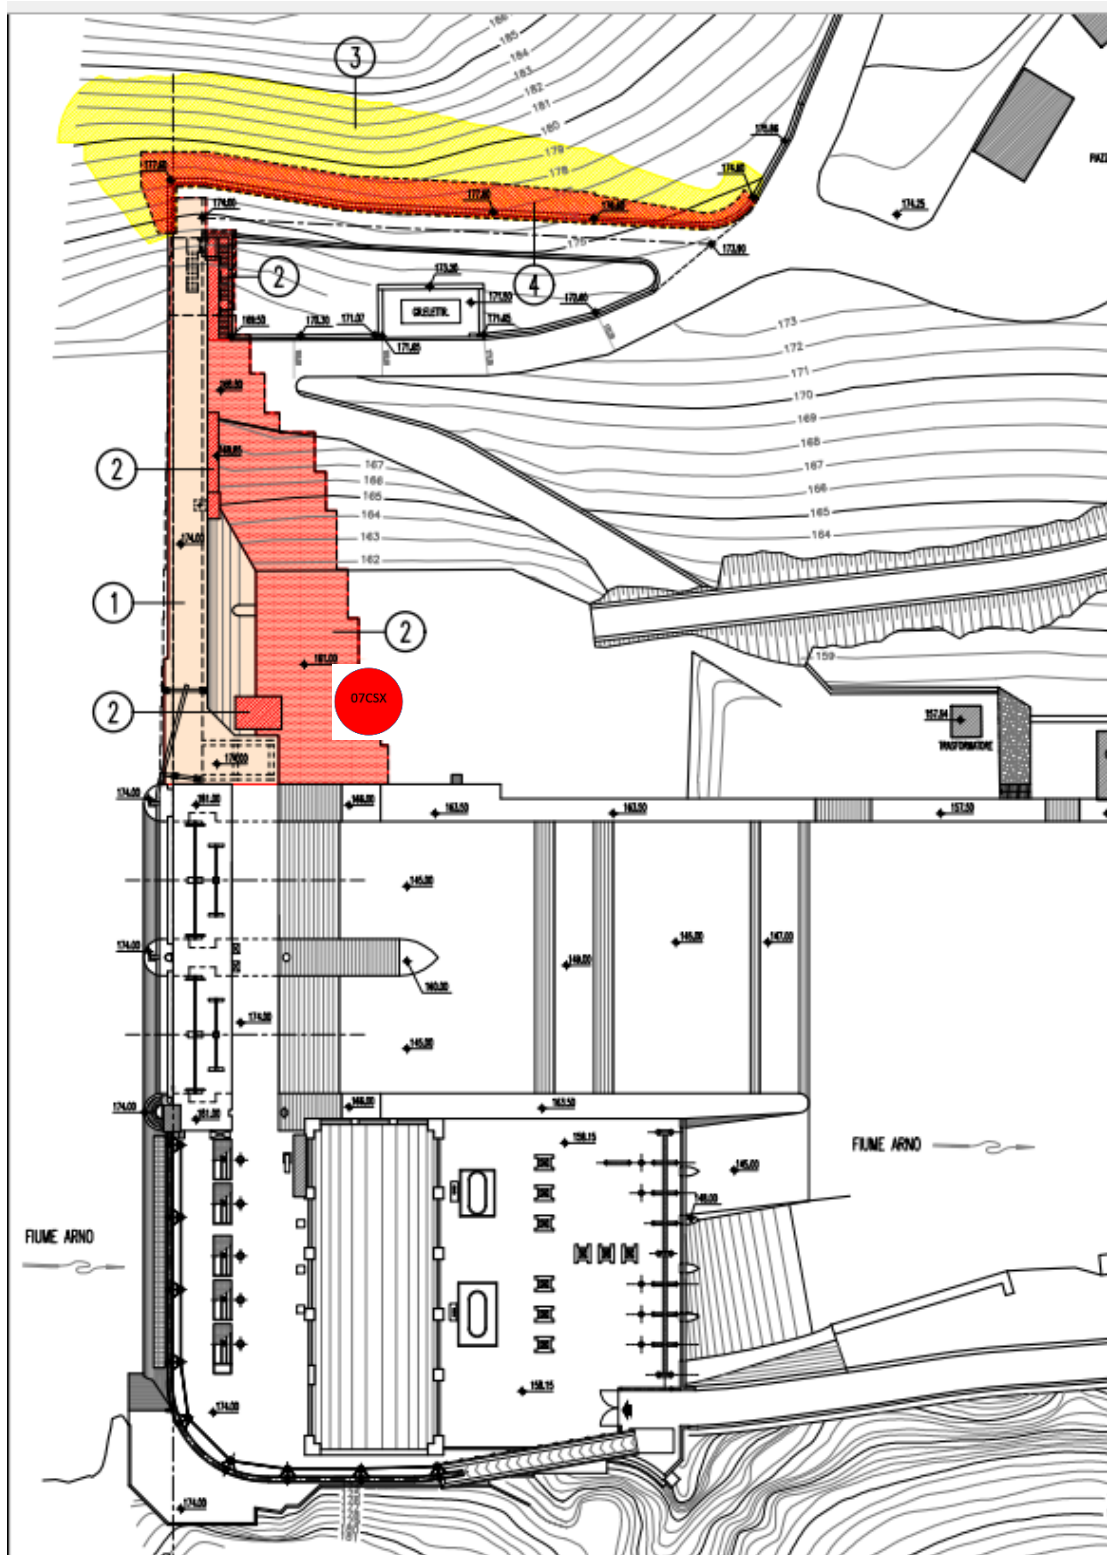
5 - INQUADRAMENTO PLANIMETRICO PUNTI CAMPIONAMENTO SPONDA SX
